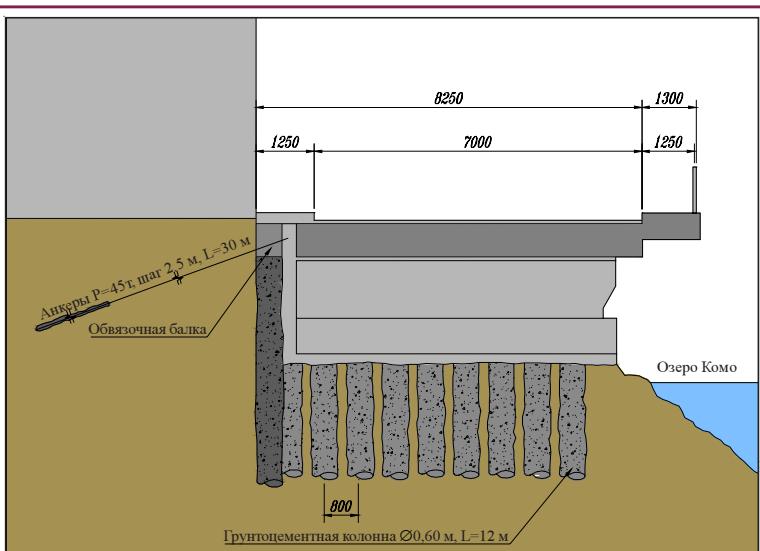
Строительство автомобильной дороги антресольного типа на берегу озера Комо. Принципиальное решение конструкции и фундаментов.
